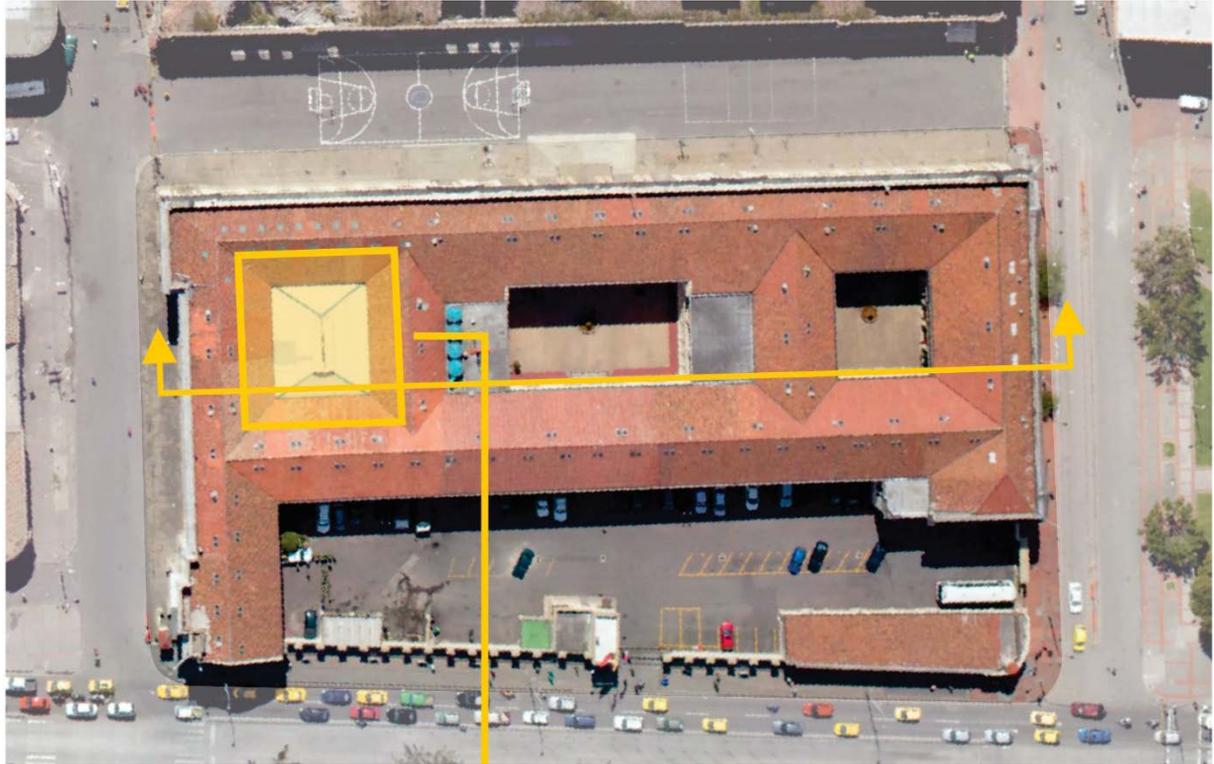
Ubicación en Planta de la cubierta del patio sur.
